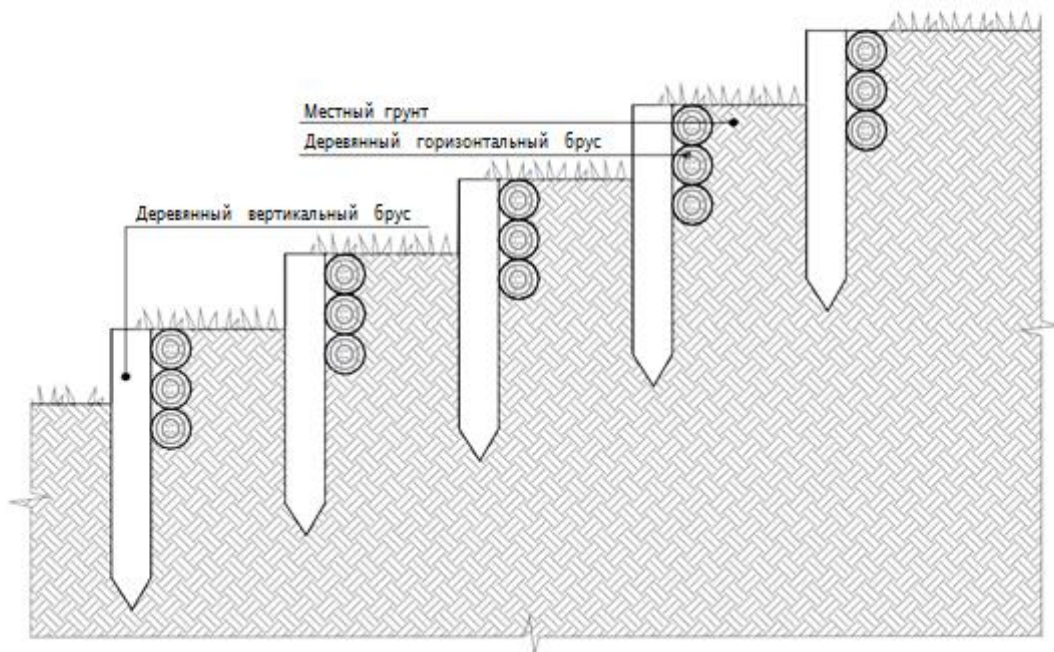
Схема устройства лестницы на естественном рельефе на деревянных столбах
